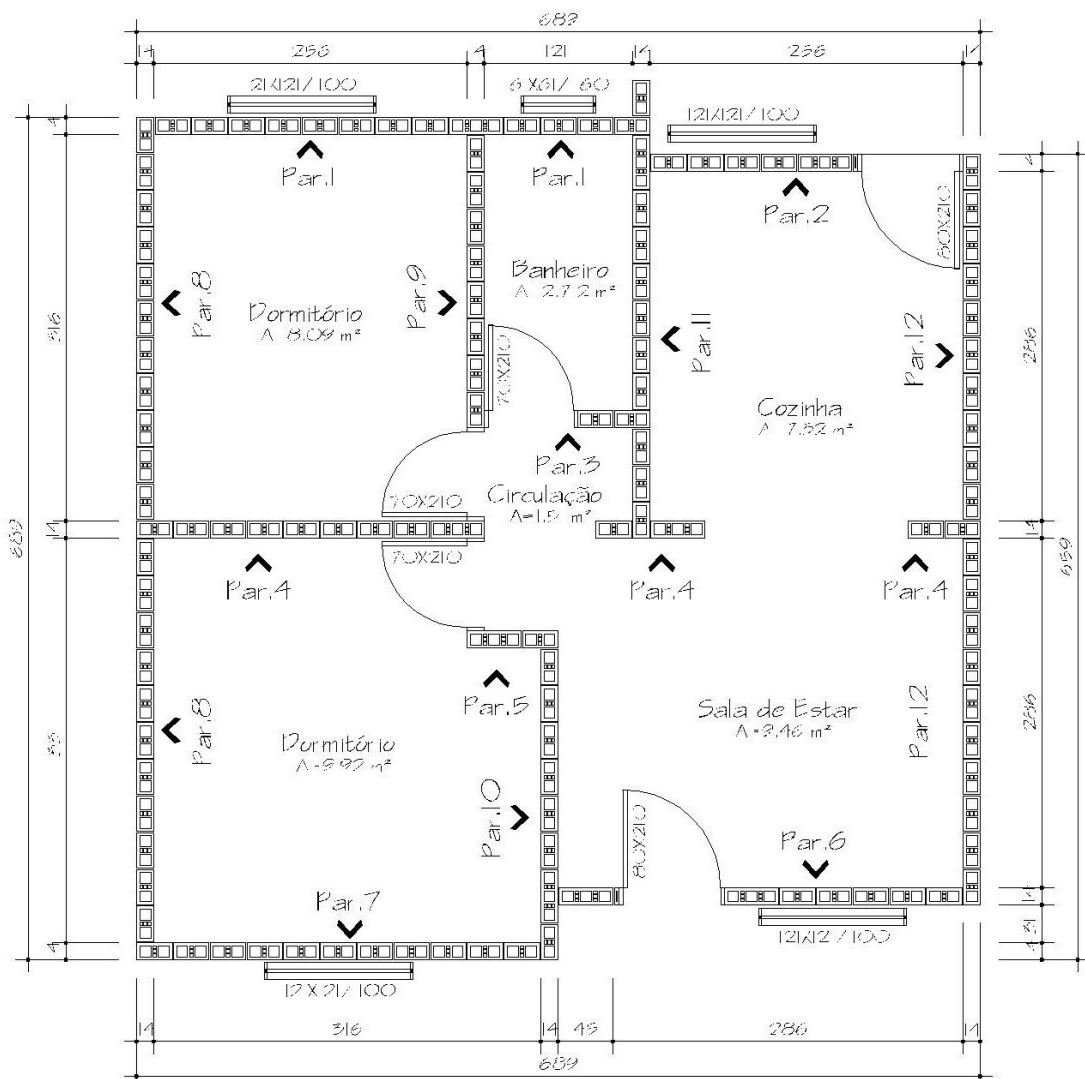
Exemplo de planta de primeira fiada (SOARES, SANTOS & POLLETTO, 2003).
